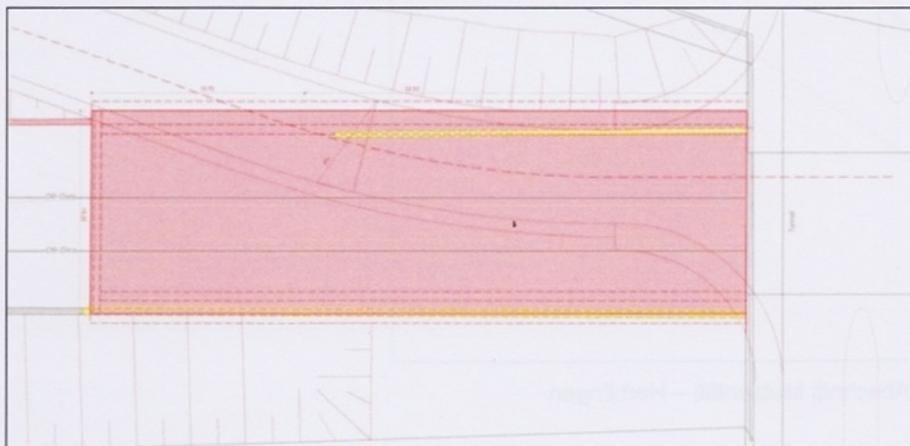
Tunnelverlängerung Anschluss Ebnatstrasse, Grundriss
